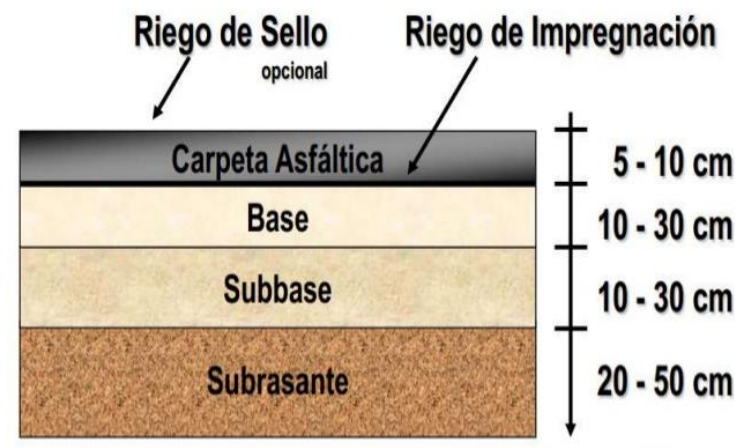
Estructura típica de pavimentos asfálticos [32]
